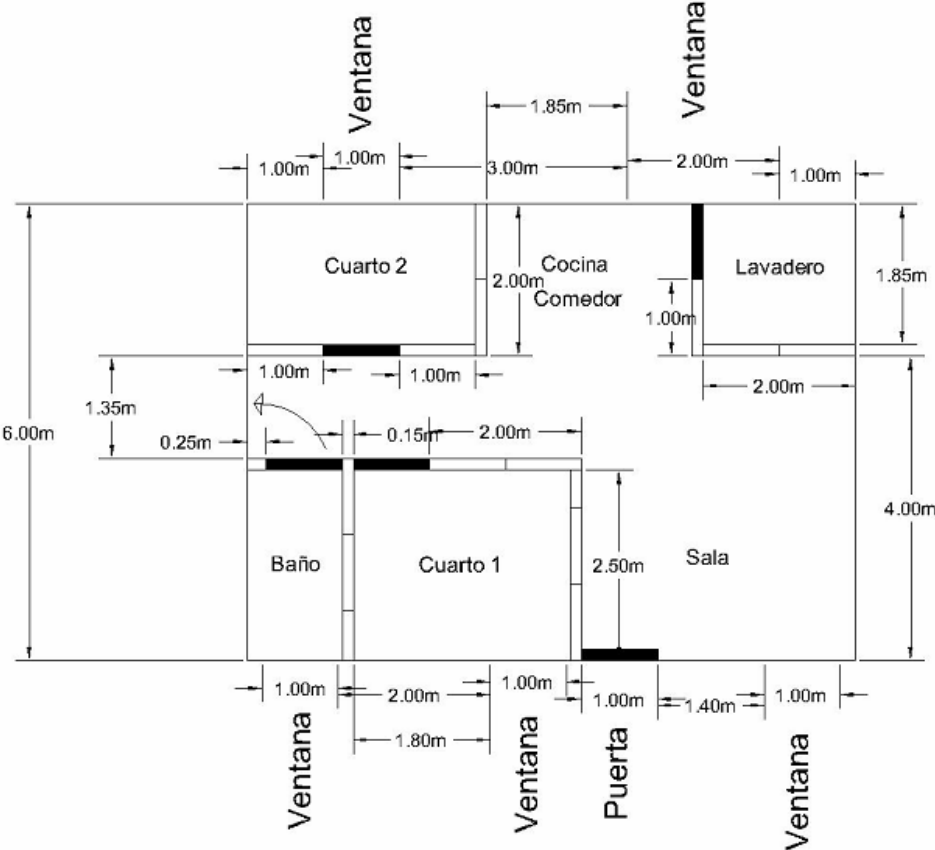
Anexo 8. Vista en planta de distribución del apartamento
